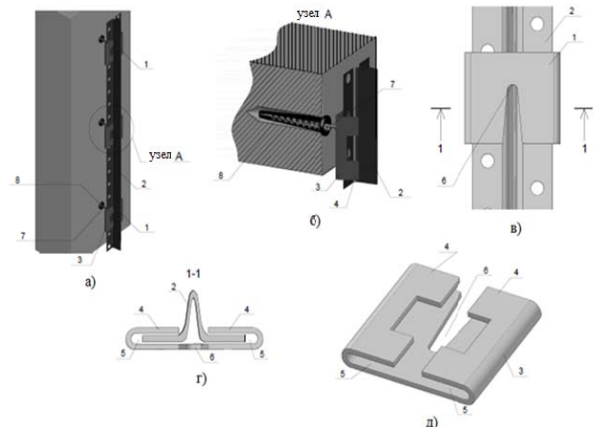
Устройство для крепления маячкового профиля: а) - готовая конструкция установленного маяка перед оштукатуриванием поверхности; б) - узел "А" этой конструкции с разрезом стены; в) - устройство для крепления инвентарного маяка, с установленным маячковым профилем, вид снизу; г) - устройство для крепления инвентарного маяка, с установленным маячковым профилем, разрез 1-1; д) – держатель для крепления инвентарного маяка, вид в аксонометрии без самого маячкового профиля
